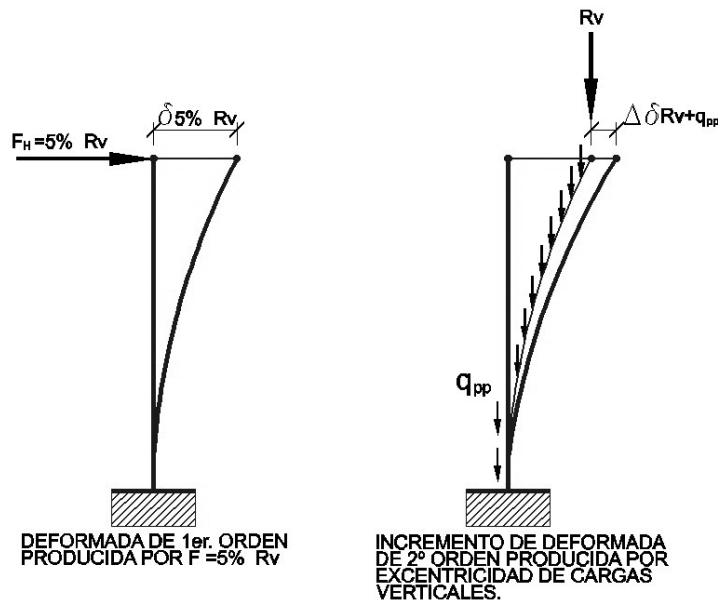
Deformadas de primer y segundo orden durante el empuje.
